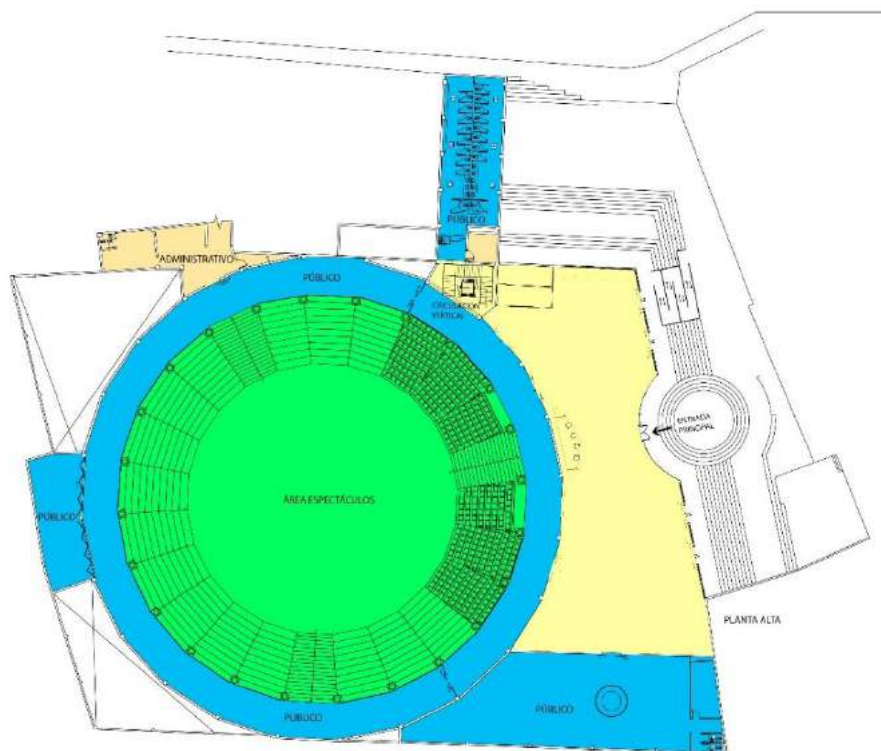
Plan masa planta alta, plaza de toros Belmonte
